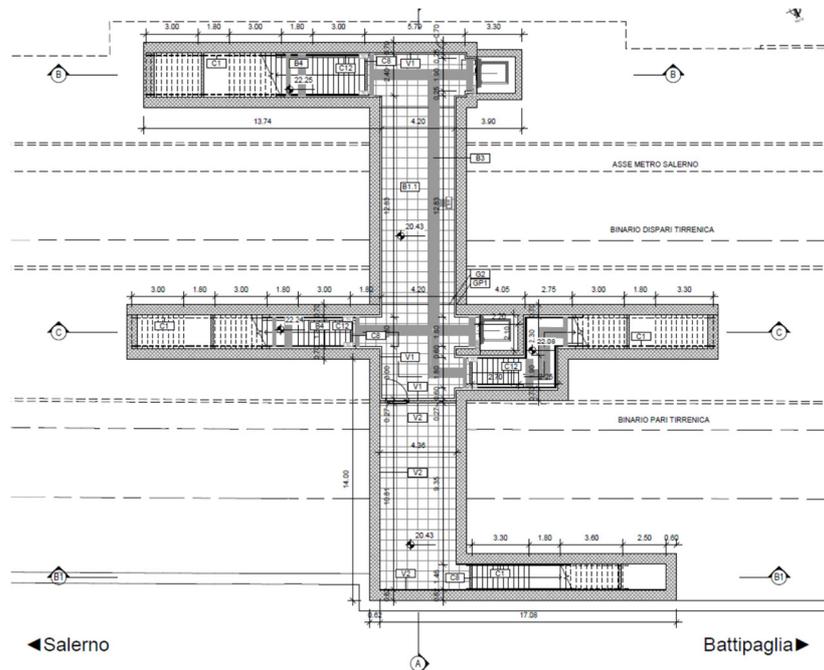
Pianta piano banchina fermata/Stazione di Pontecagnano
